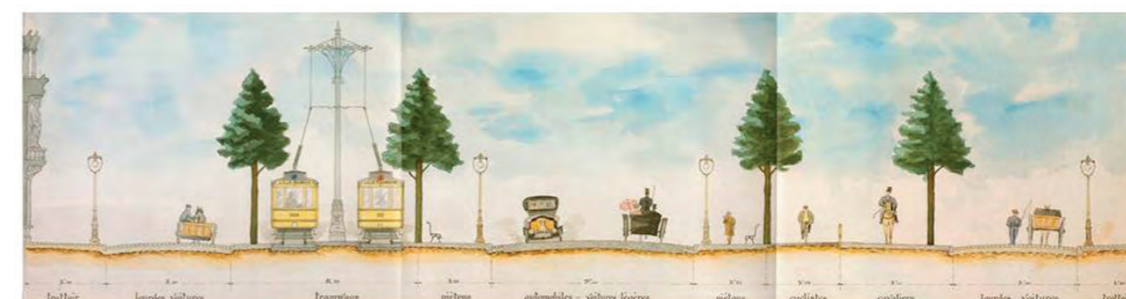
Profil en travers du Grand Boulevard (branche lilloise)
